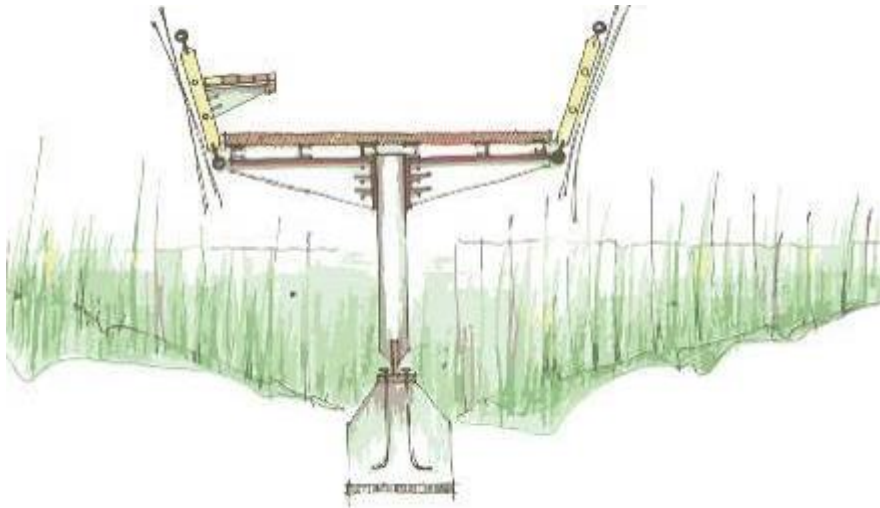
/ Croquis de corte pasarela sobre humedal / Fuente: elaboración propia
